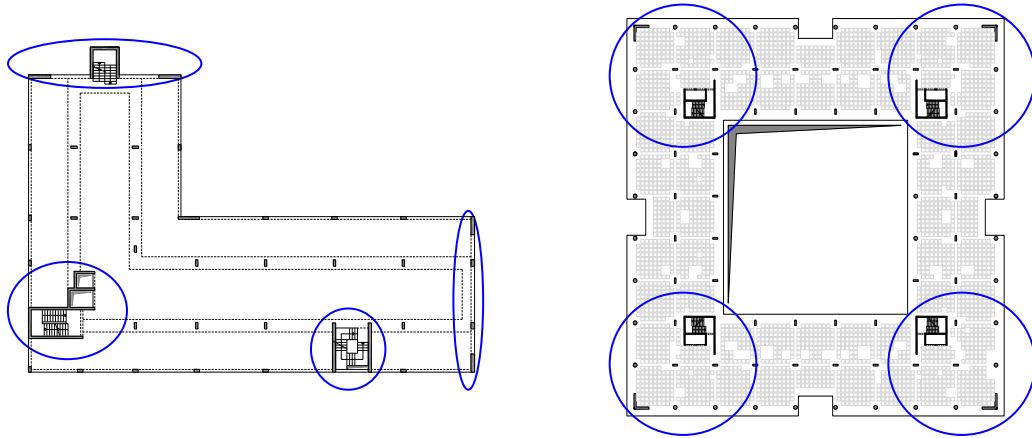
Concepção com blocos estruturais únicos. (a) Planta em L e (b) Planta com vazio interior
